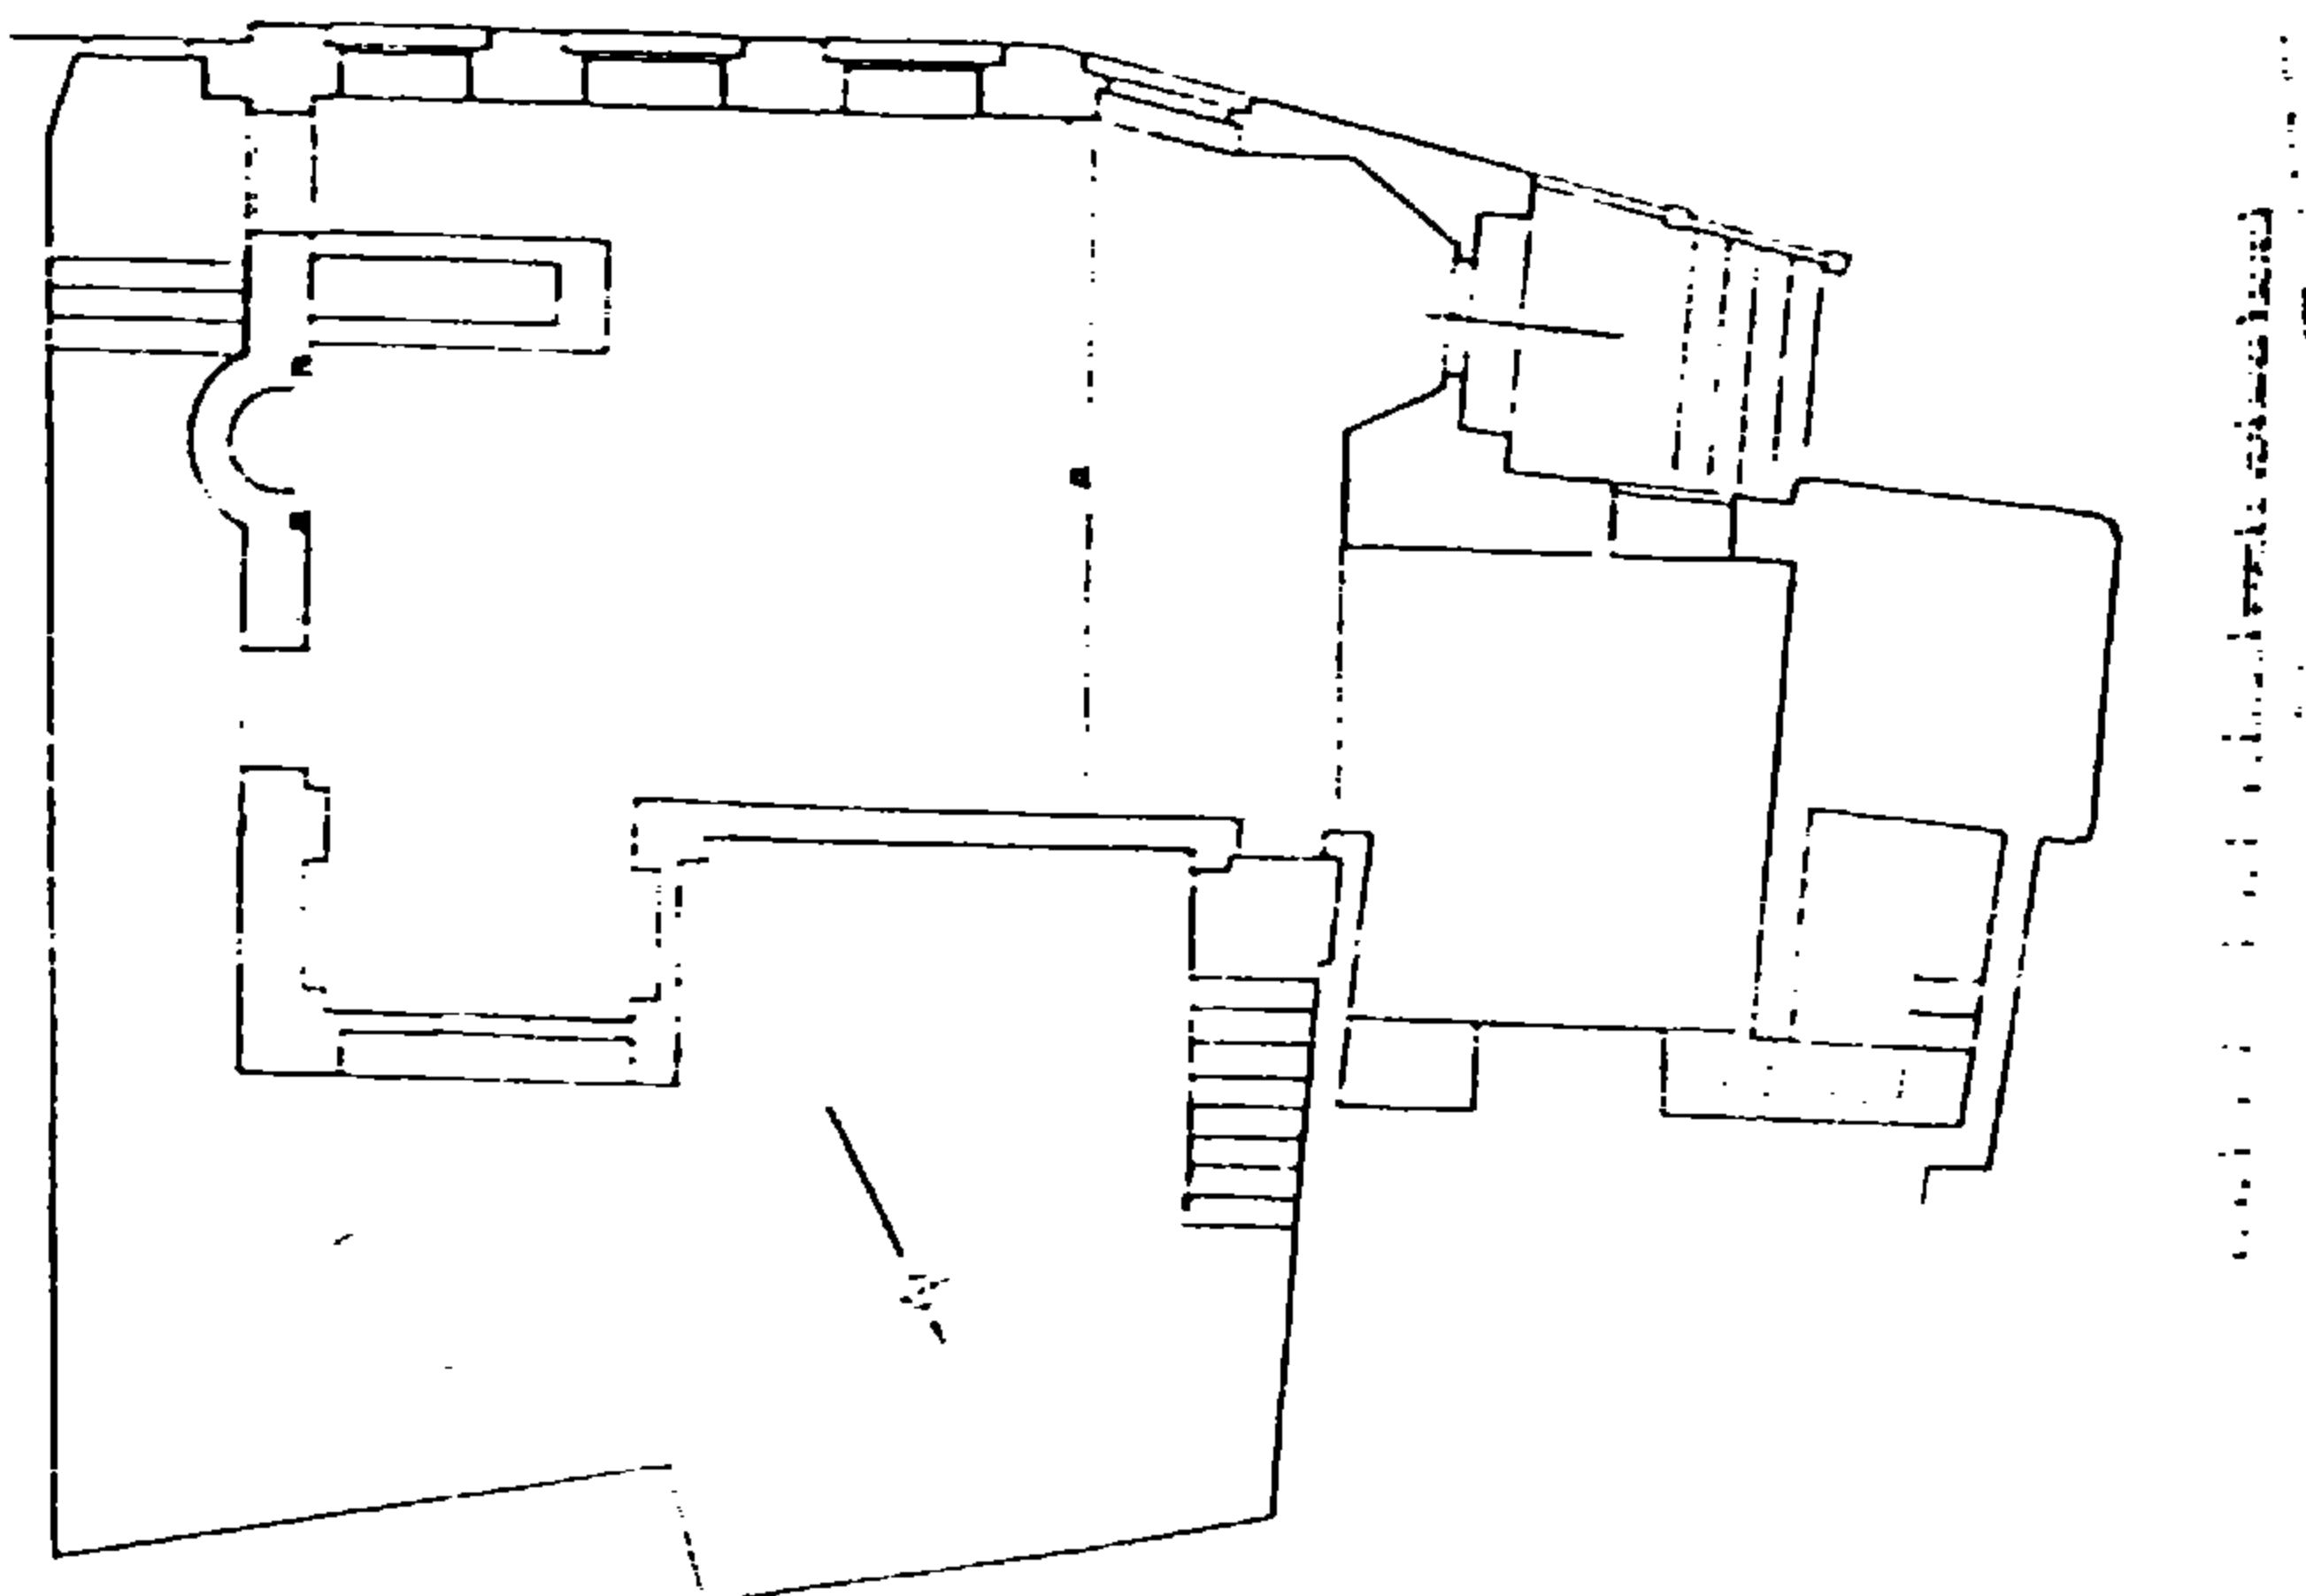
المسقط الأفقي لجامع الشواذلية
